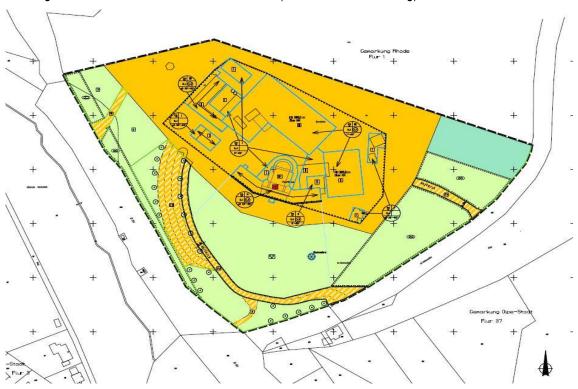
Geltungsbereich Bebauungsplan 102 (2007)
